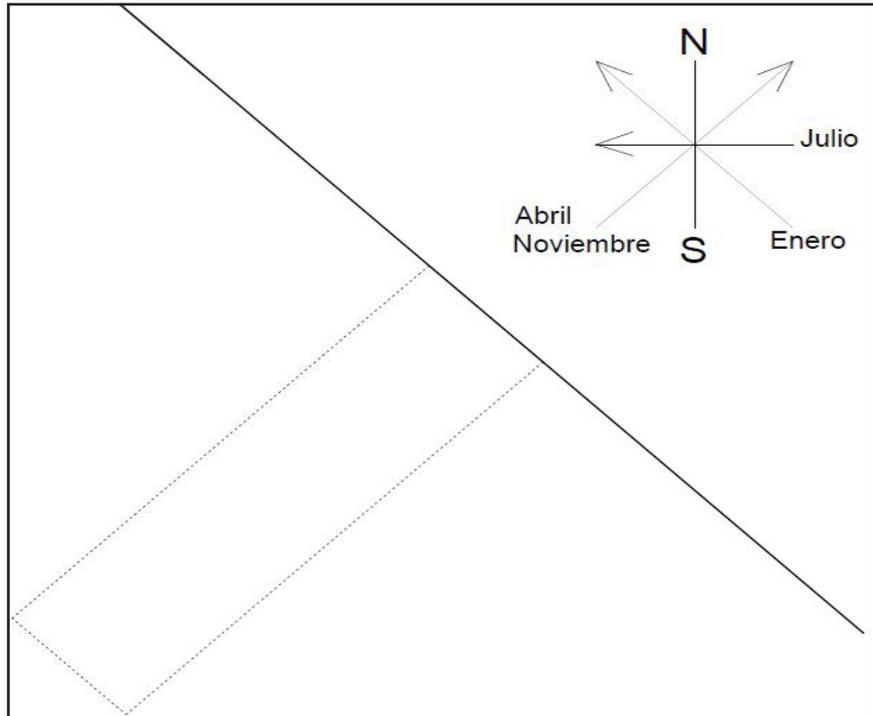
, esquema en planta de la orientación. (2014) Imagen de autor.
